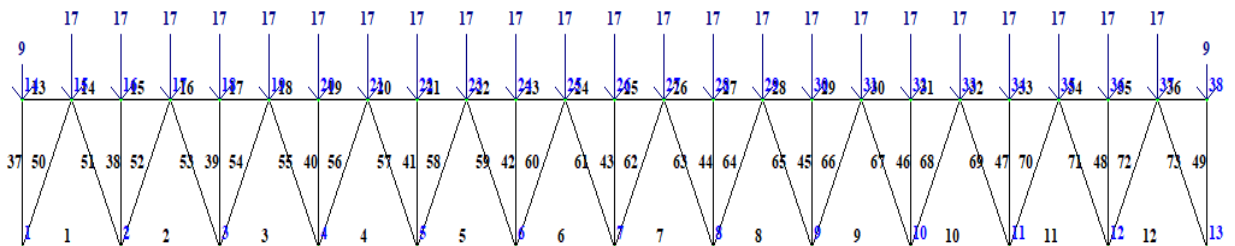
Розрахункова схема фермової конструкції покриття
